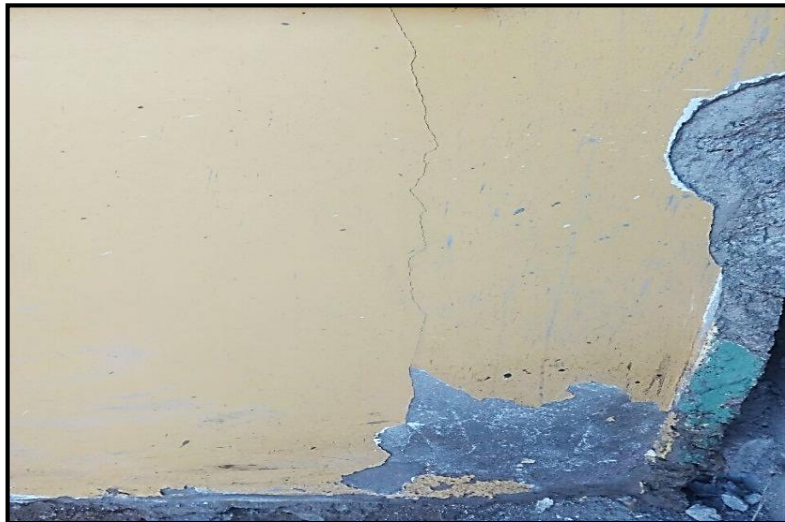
Fisura en un muro de albañilería debido a maquinaria pesada usada en una construcción vecina. Fuente: investigación propia (2018).
